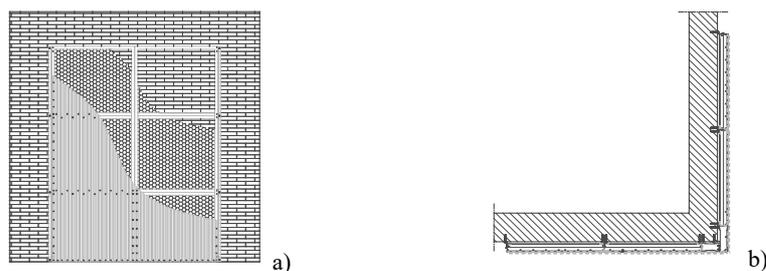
Installazione del sistema sulla facciata dell'edificio: vista frontale (a) ed in pianta (b)
